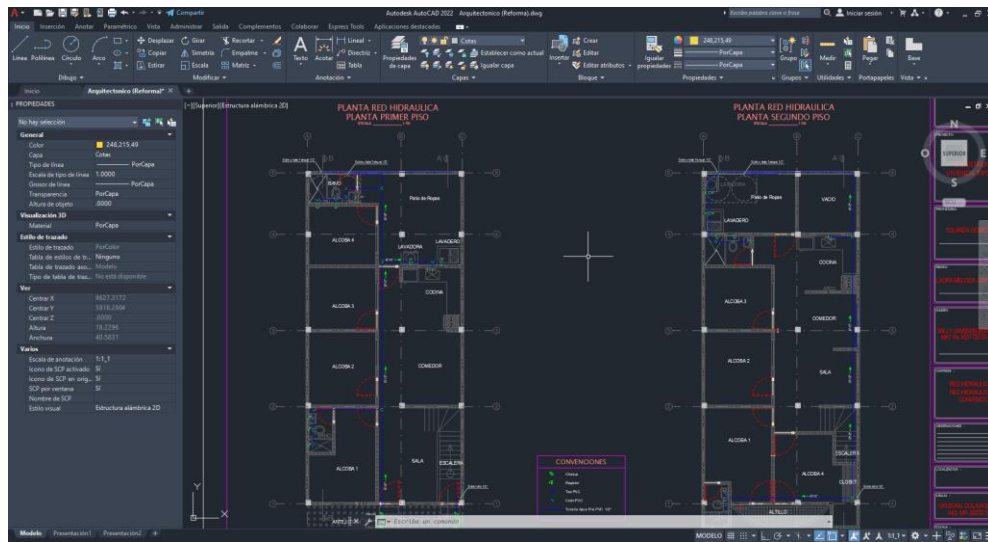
Plano Hidráulico. AutoCAD. Fuente elaboración propia.
